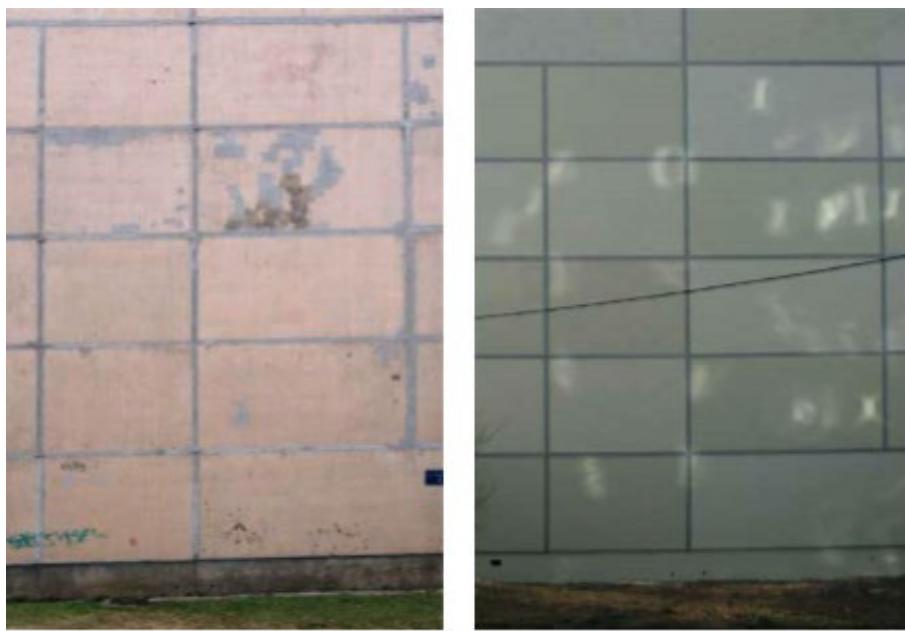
Стены панельных зданий до и после проведения работ по системе ППШ
